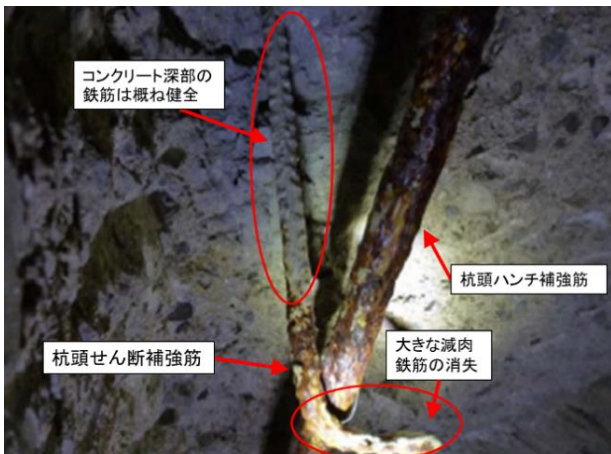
杭頭せん断補強筋腐食状況 (図-3 ①)
